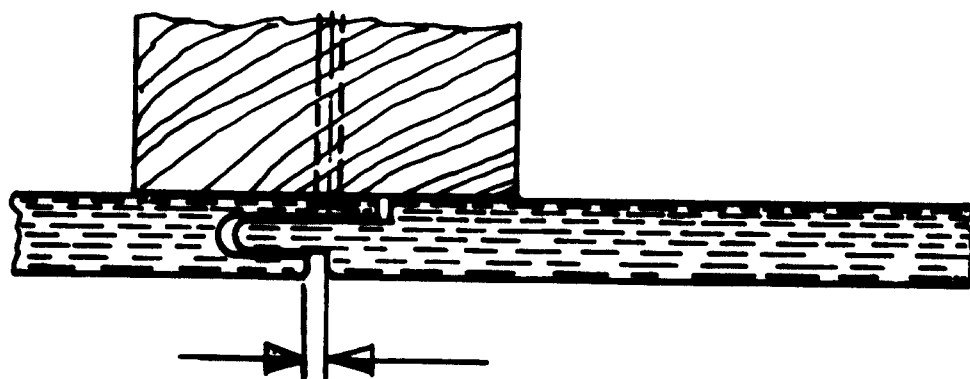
FIGURE X. DETAILS DE CONSTRUCTION POUR RENFORCER DES ELEMENTS
